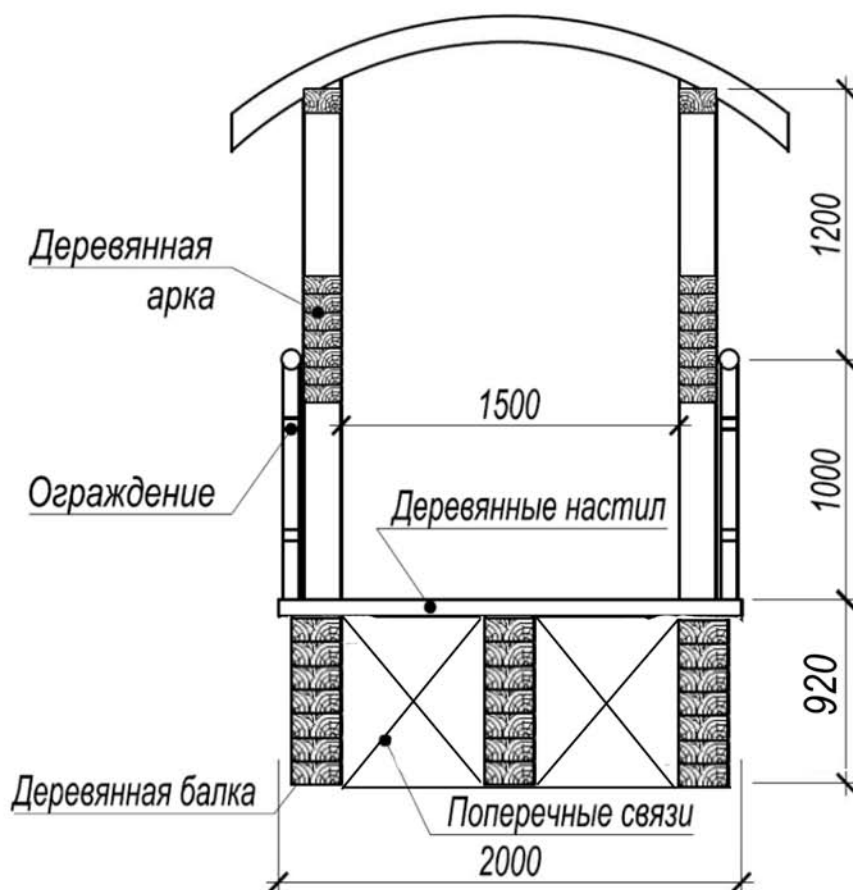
Поперечный разрез надземного пешеходного перехода с несущими деревянными балками пролетом 18 м
